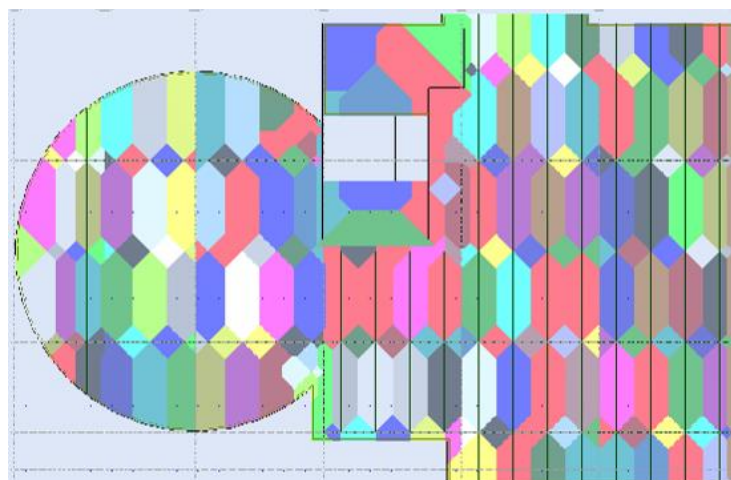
Розрахункова схема плити перекриття: 3D –моделі (а,б);
